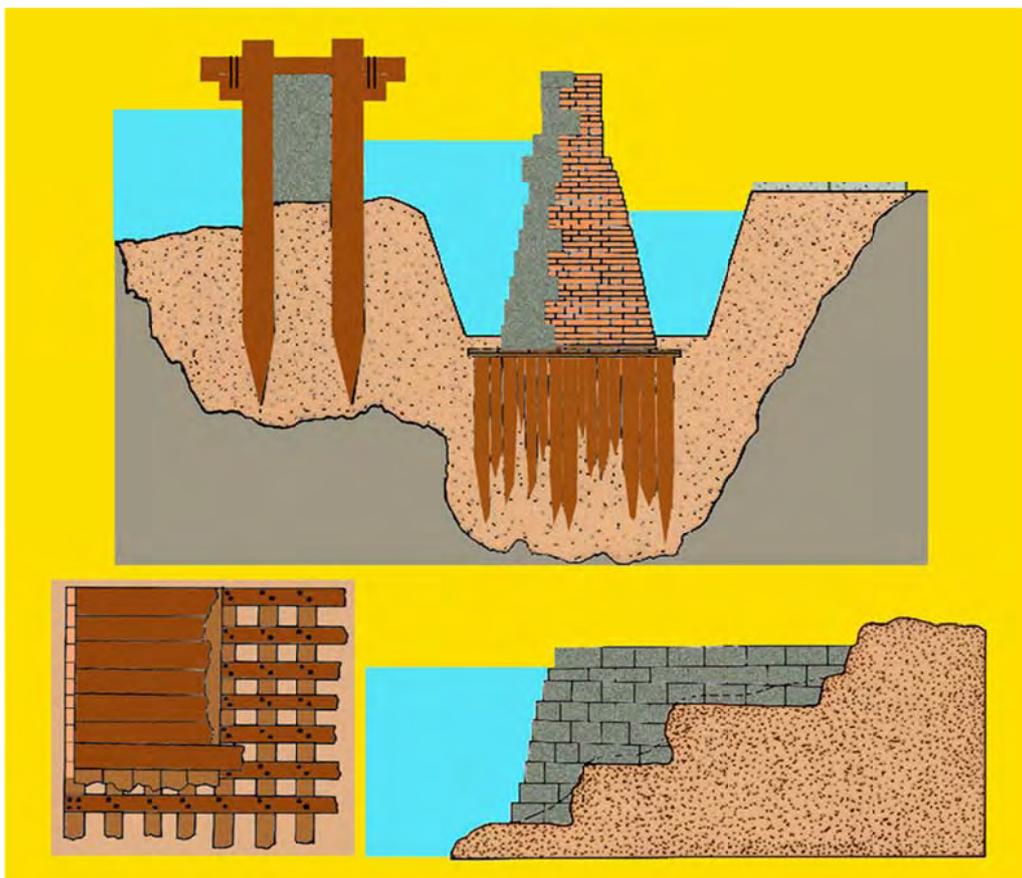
Пример конструкции фундамента (рис. Corrado Balistreri Trincanato, Omar Benetti)
